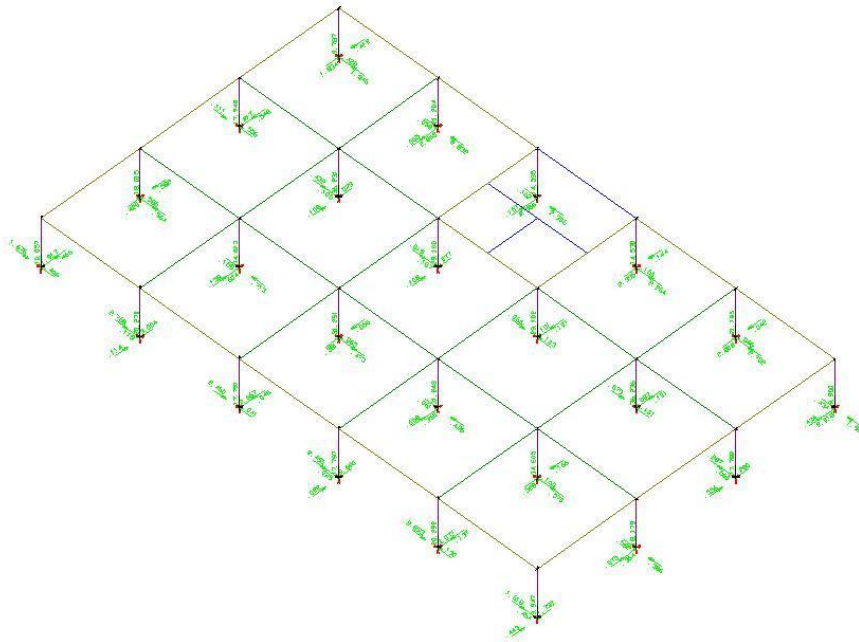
pórtico espacial do 1º pavimento com as reações de apoio.
